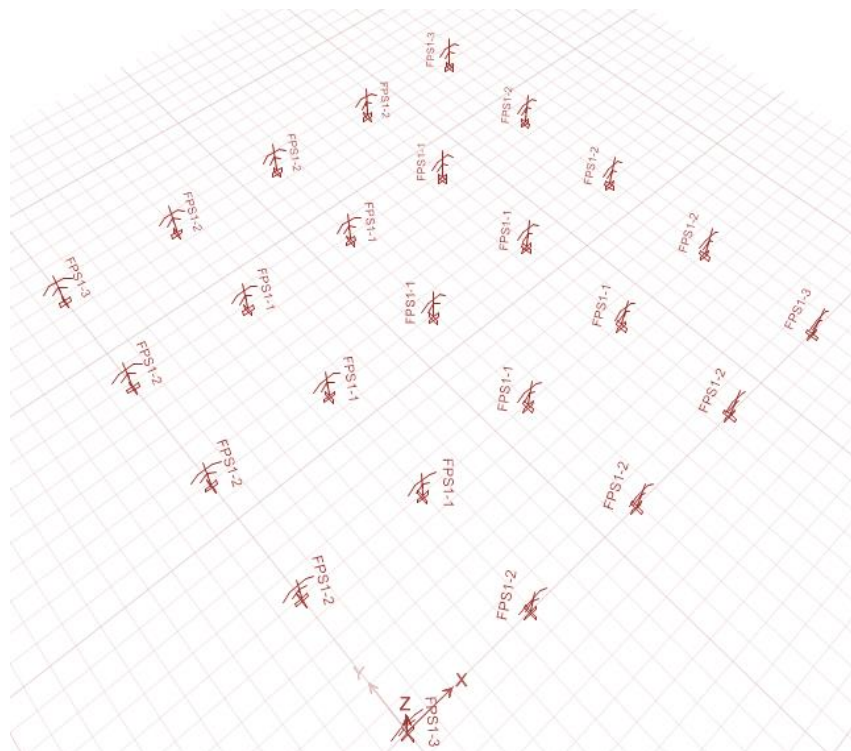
Distribución en Planta Aisladores tipo FPS (Microzona Lacustre 200). Fuente: Propia.
